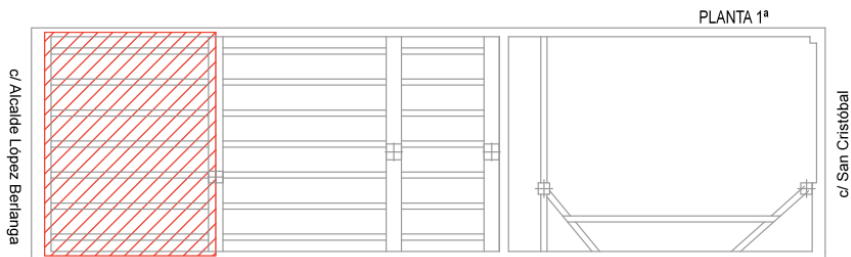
Zona afectada en el refuerzo de forjado. Fuente propia.
